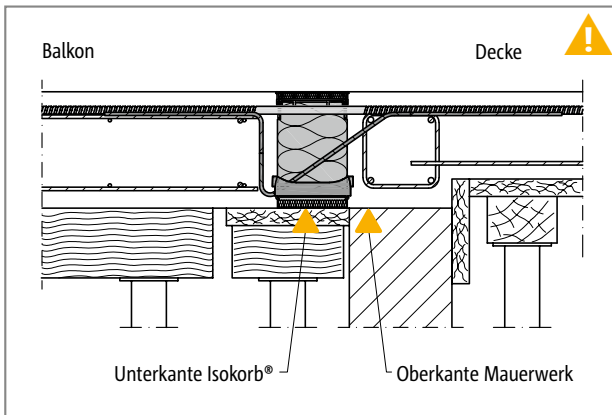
Schöck Isokorb® CXT Typ K: Ortbetonbalkon mit höhenversetzer Decke auf Mauerwerkswand
